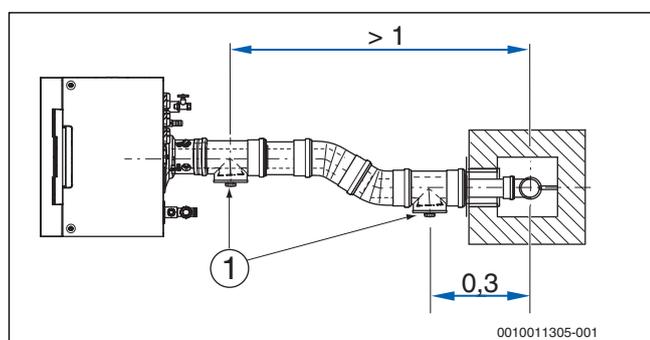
Esempio: collocazione delle aperture d'ispezione con deviazione nel locale di posa (misure in m)
